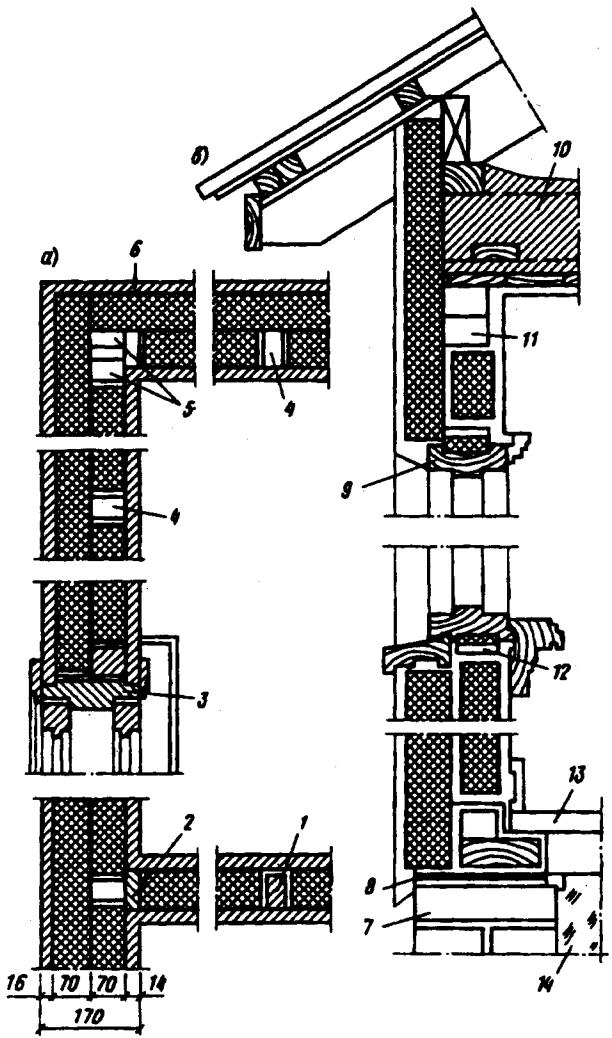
Детали конструкций каркасного дома с утеплением стен фибролитовыми плитами
